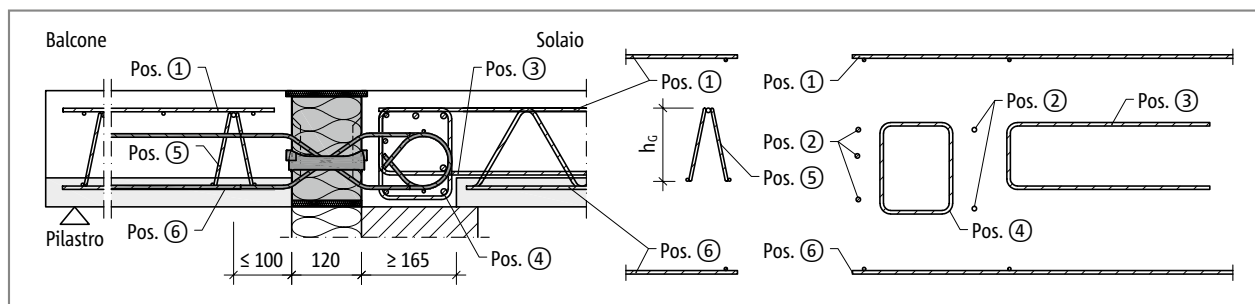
Schöck Isokorb® XT tipo QL-V1 a QL-V4: armatura in opera con reticolo di supporto
